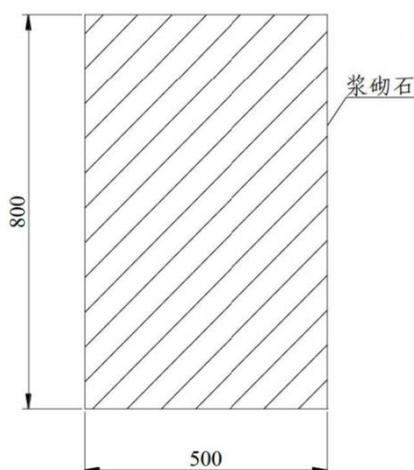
挡土保水岸墙典型设计图 单位：mm
